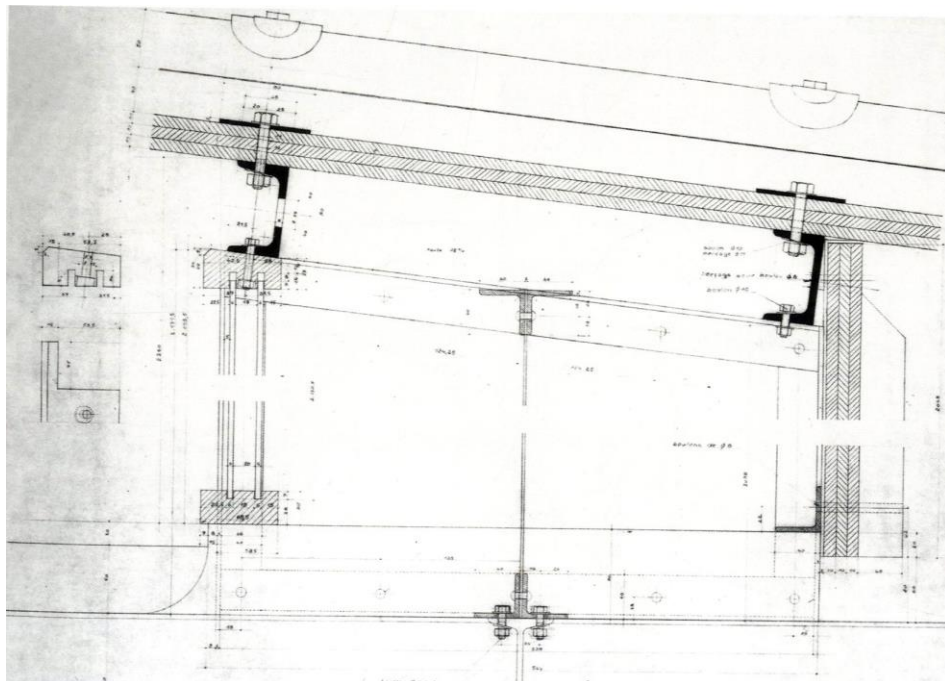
détail de toiture en panneaux Rousseau, Maison Prouvé, Nancy
